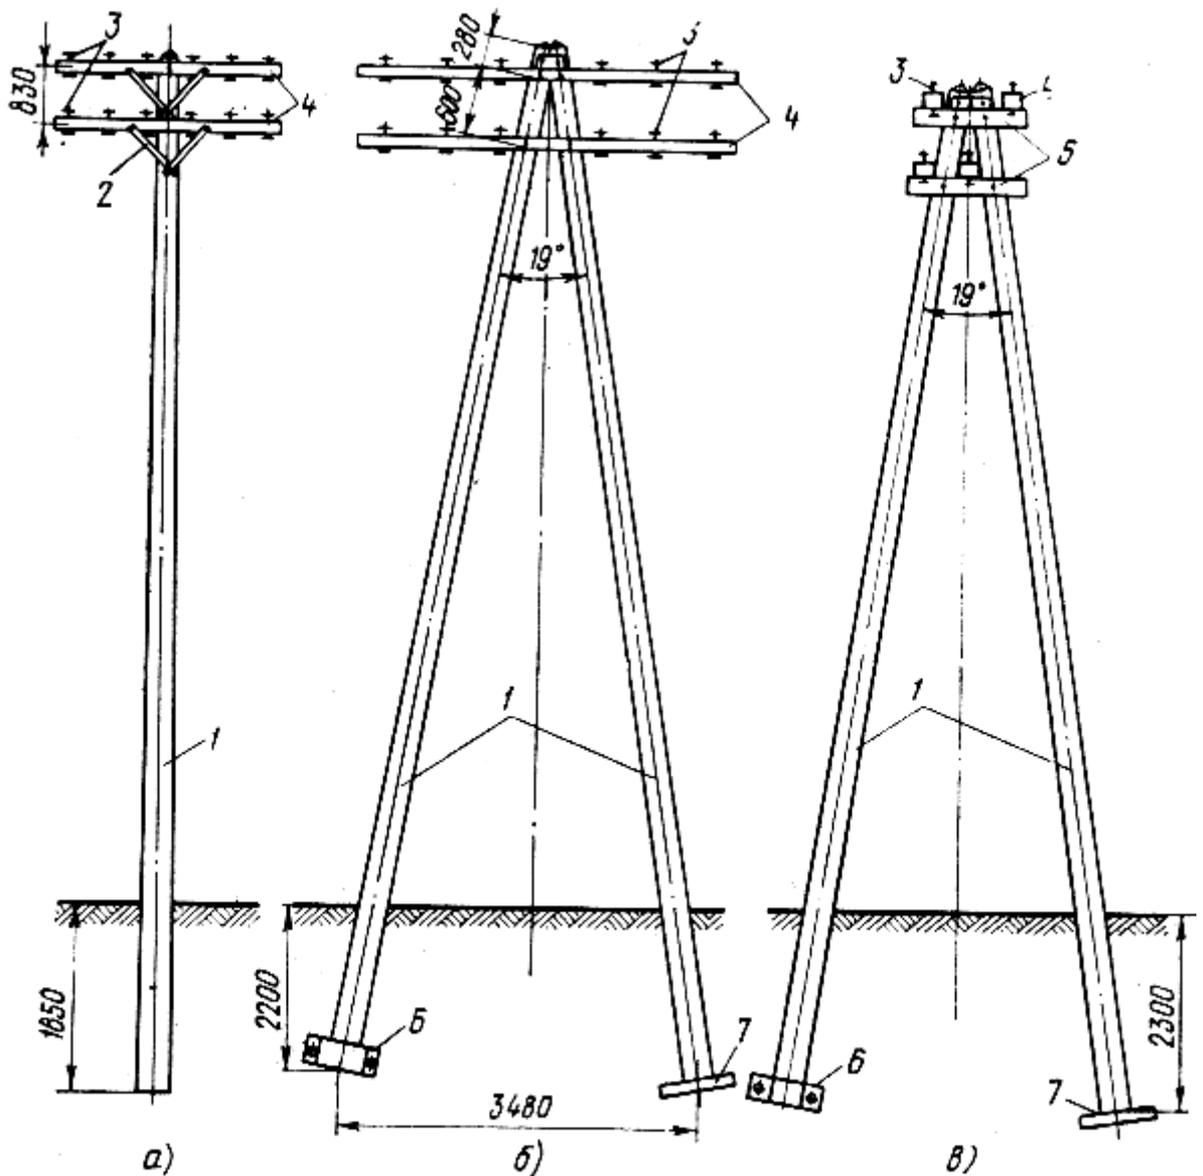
Железобетонные опоры ВЛ до 1 кВ:
